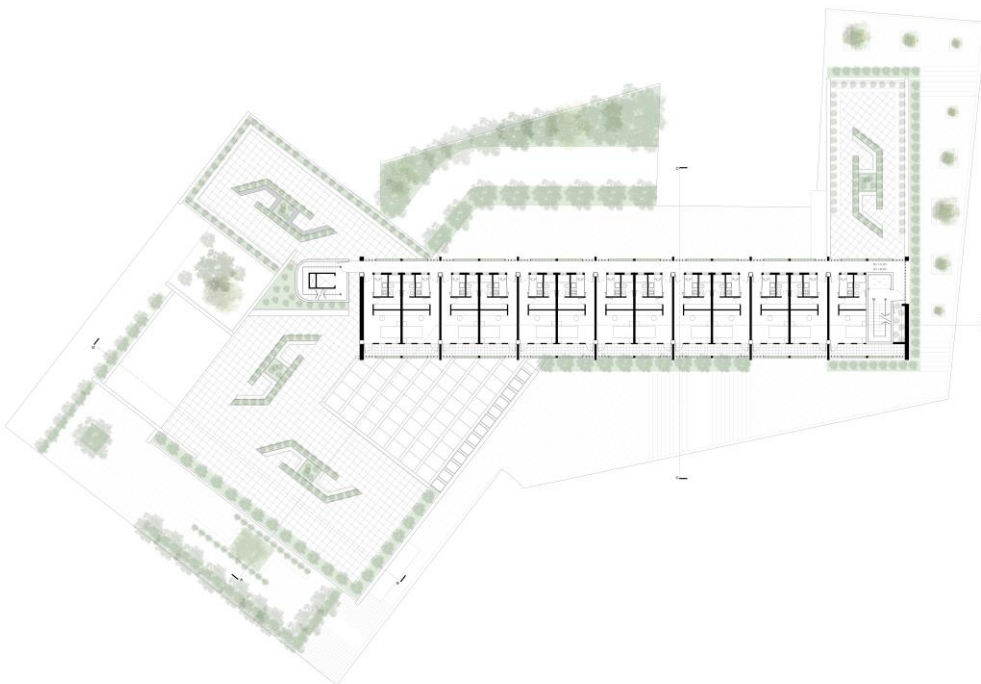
Planta 1 nivel de ingreso - Nivel +3.60. Por: Elaboración propia.
